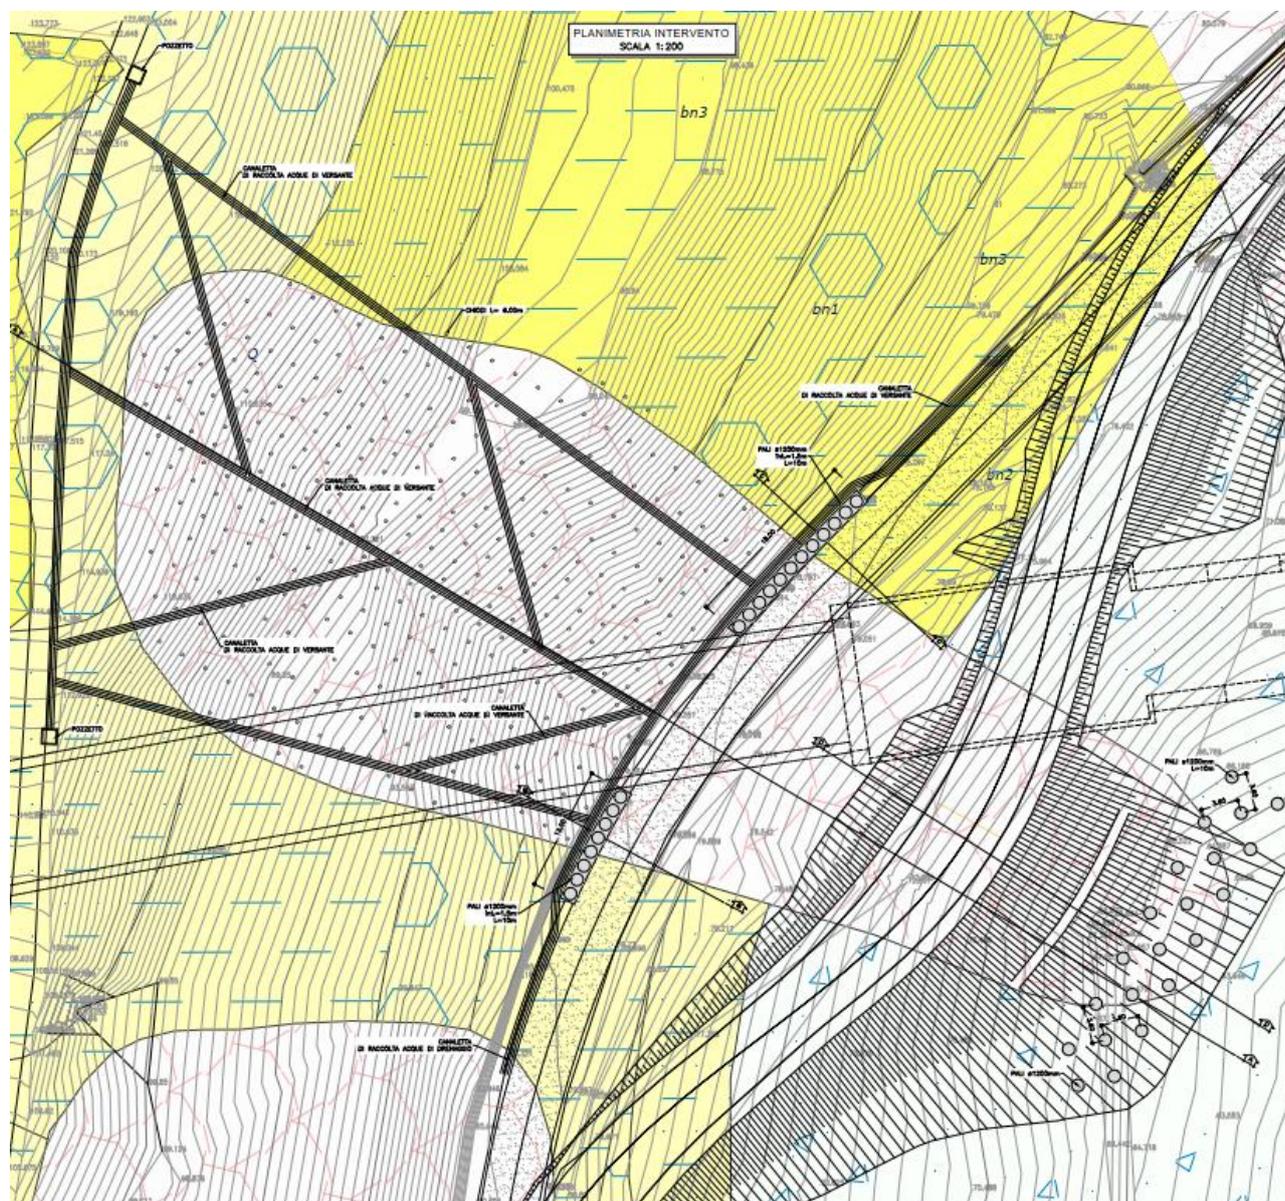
Galleria Cantone. Imbocco lato Benevento. Planimetria sistemazione definitiva
